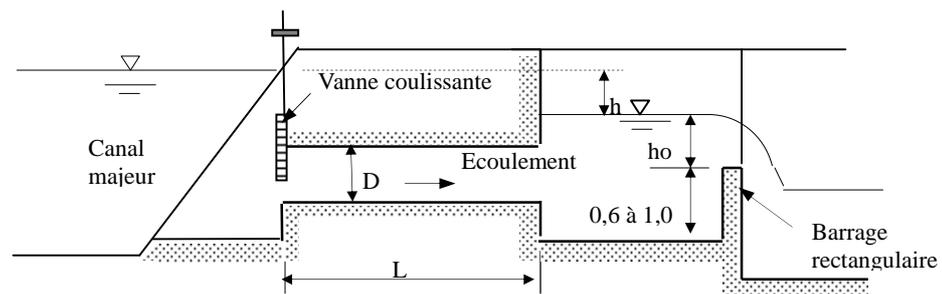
Plan longitudinal du partiteur de type tuyau
